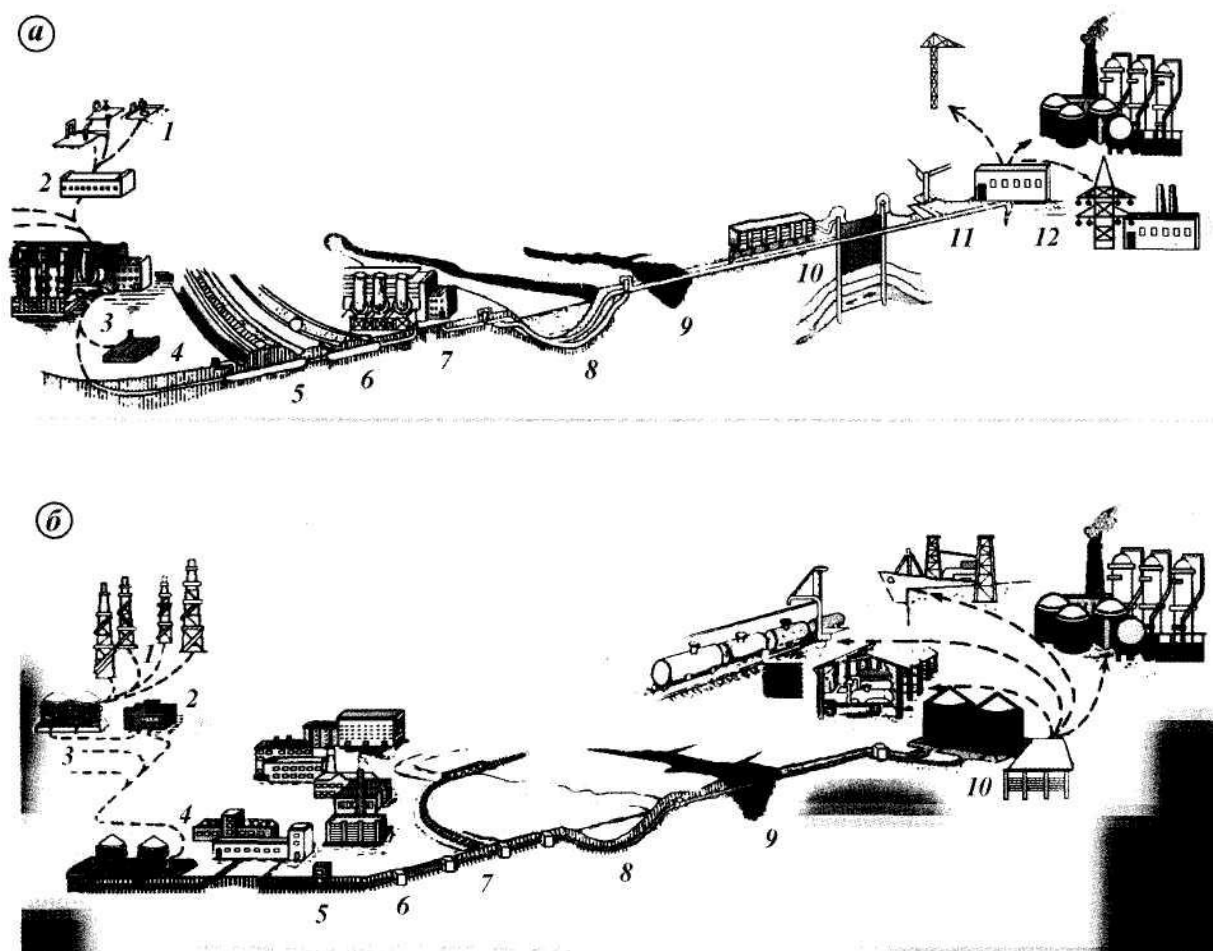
Схемы сооружений магистрального газопровода (а) и нефтепровода (б):
